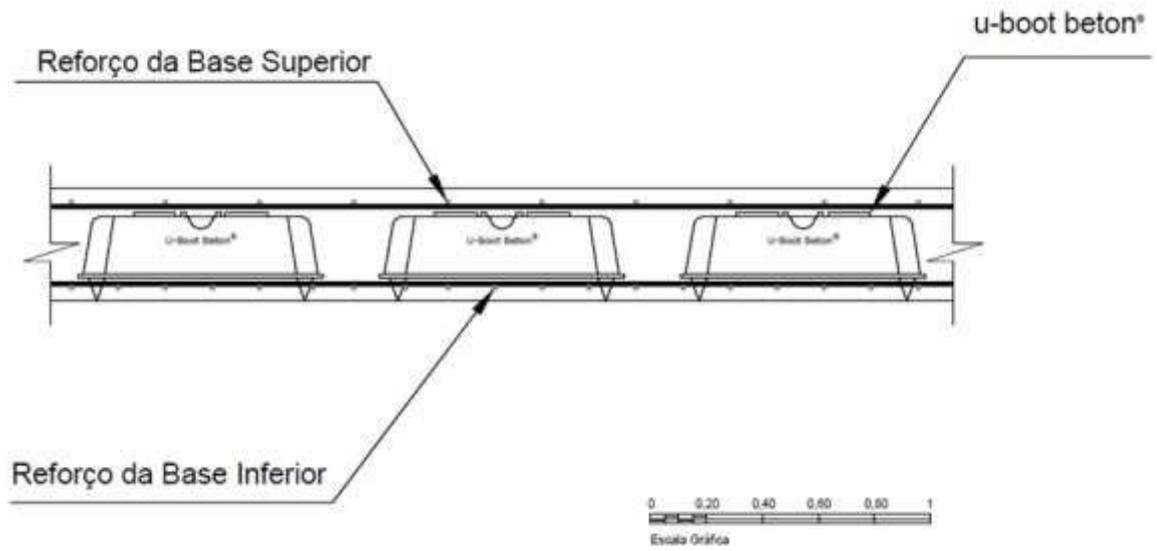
Detalhamento – Laje *U-Boot Beton®
